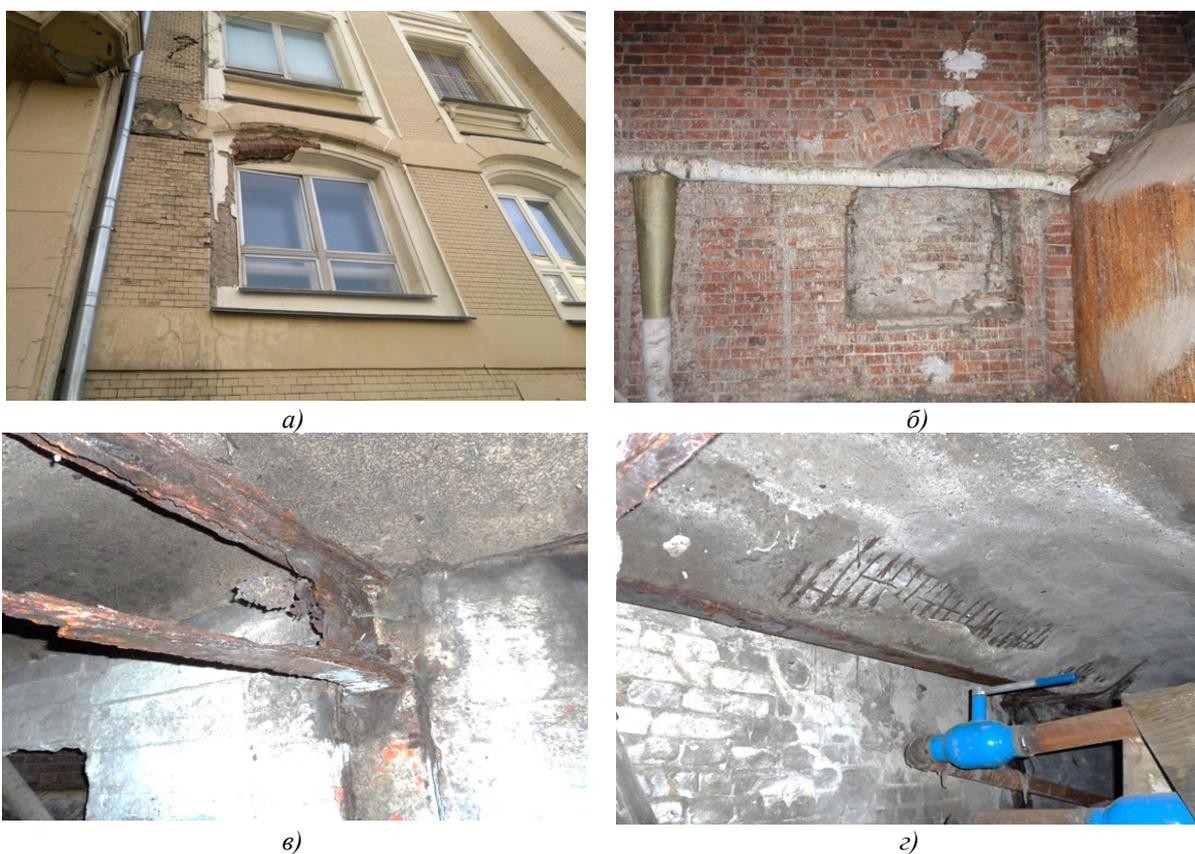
Данные обследования исторического здания: а) сквозные трещины раскрытием более 50 мм на наружных стенах по всему периметру сооружения; б) разрушение штукатурного слоя на фасадах; в) сквозная коррозия стальных балок перекрытий; з) коррозия арматуры бетонных сводов подвальных помещений
